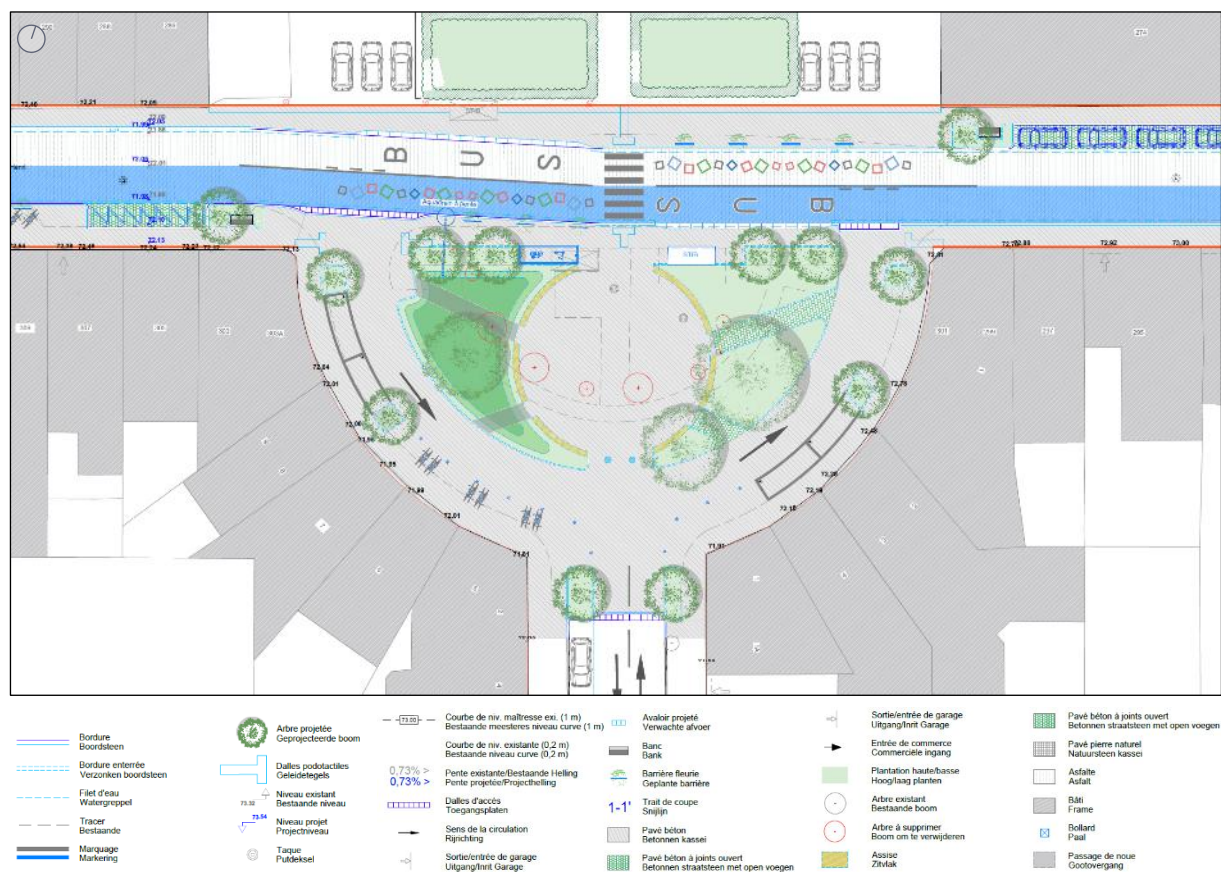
Plan projeté de la place J.B. Degroof (source : Demandeur)
